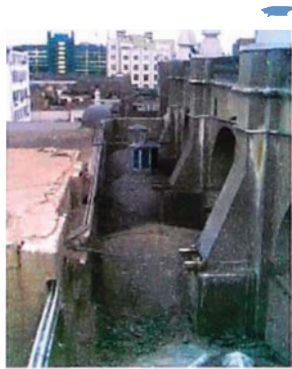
Vista exterior de bóveda ubicada hacia el muro postrero del lado de la puerta de los Naranjos.
